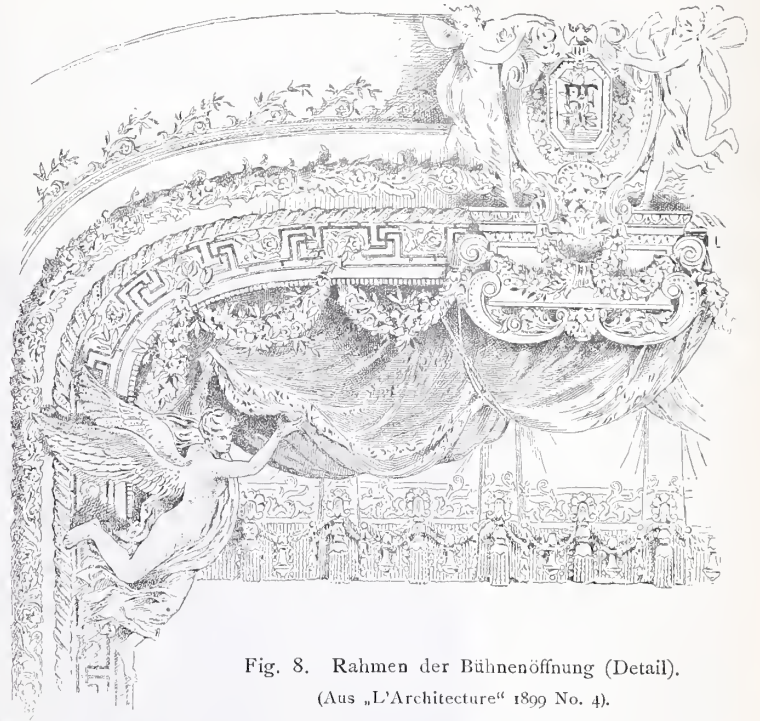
Rahmen der Bühnenöffnung (Detail).
